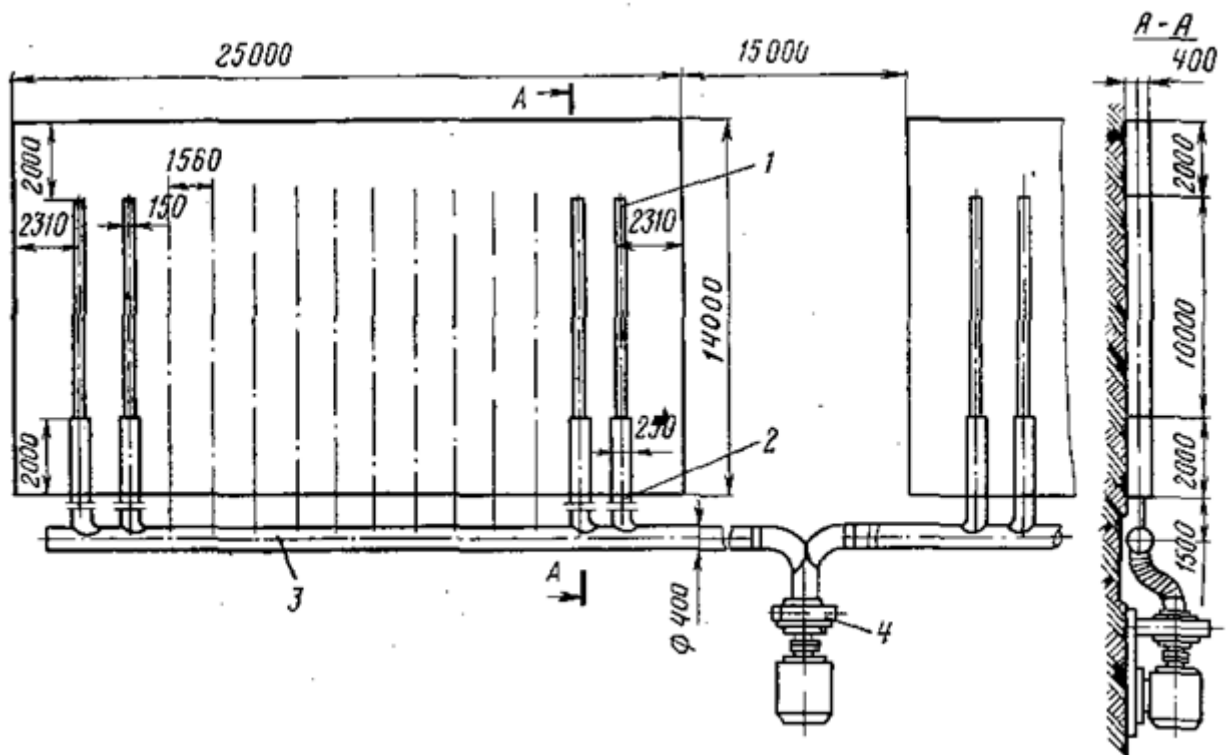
Схема установки для отсоса воздуха из бунта хлопка-сырца.
